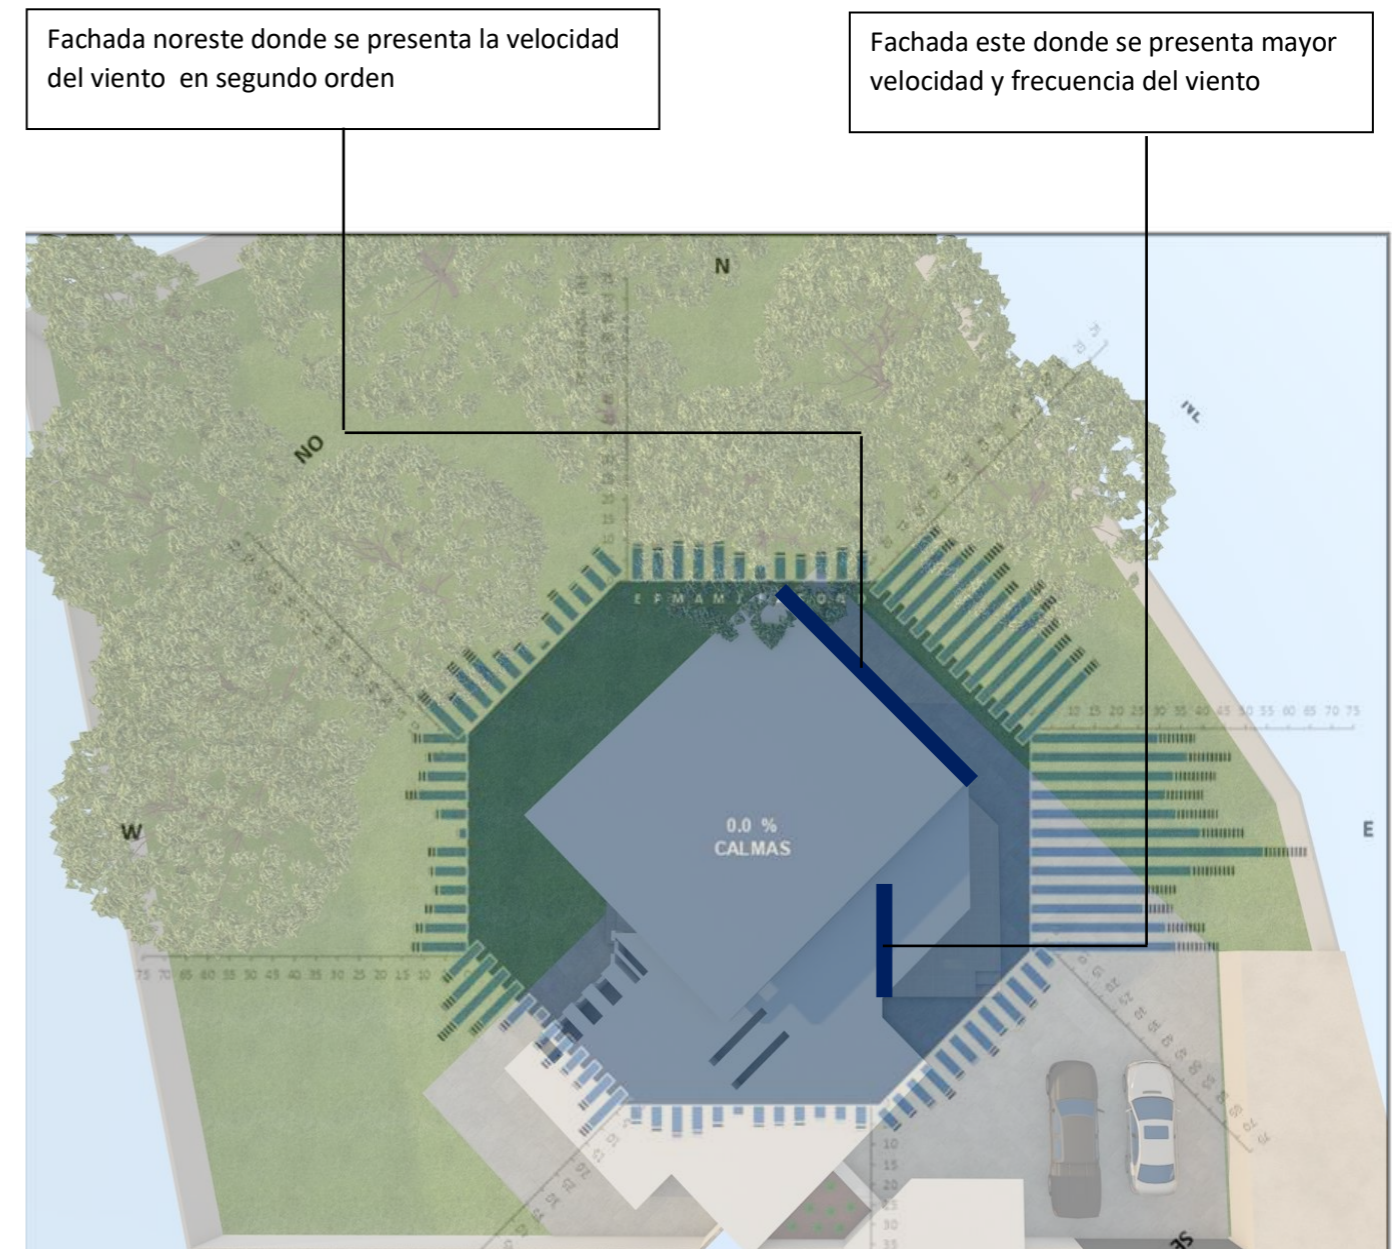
Rosa de los vientos en Teotitlan de Flores Magon sobre planta de conjunto (propia, Elaboración)
